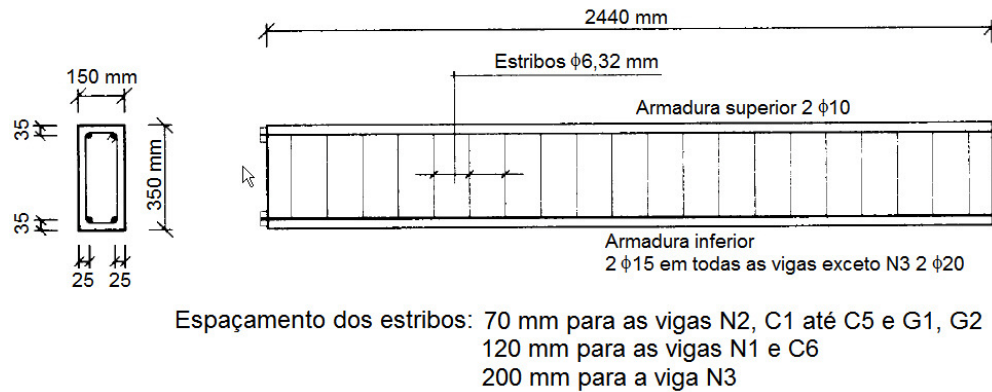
Detalhe das vigas ensaiadas (Ghobarah *et al.*, 2002).
